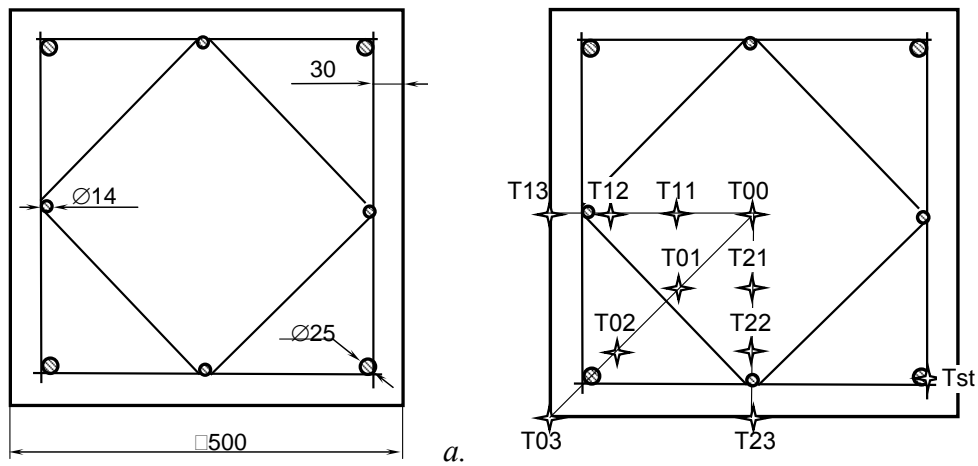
Схема армирования (а) и схема расположения термопар (б) железобетонной колонны.
